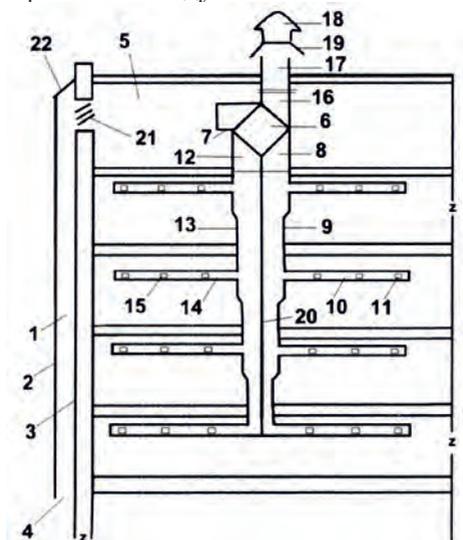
Рекуперативное устройство приточно-вытяжной вентиляции здания: 1 – вертикальный воздухопроводящий канал;
